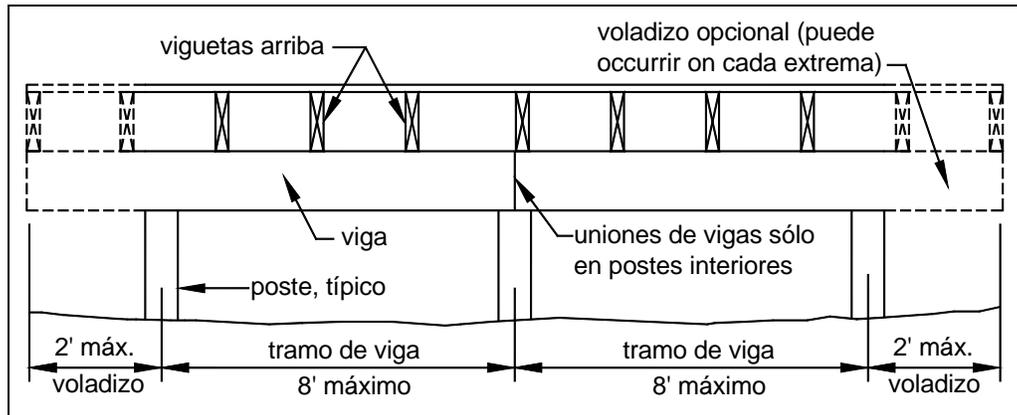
TIPOS DE TRAMOS DE VIGAS
